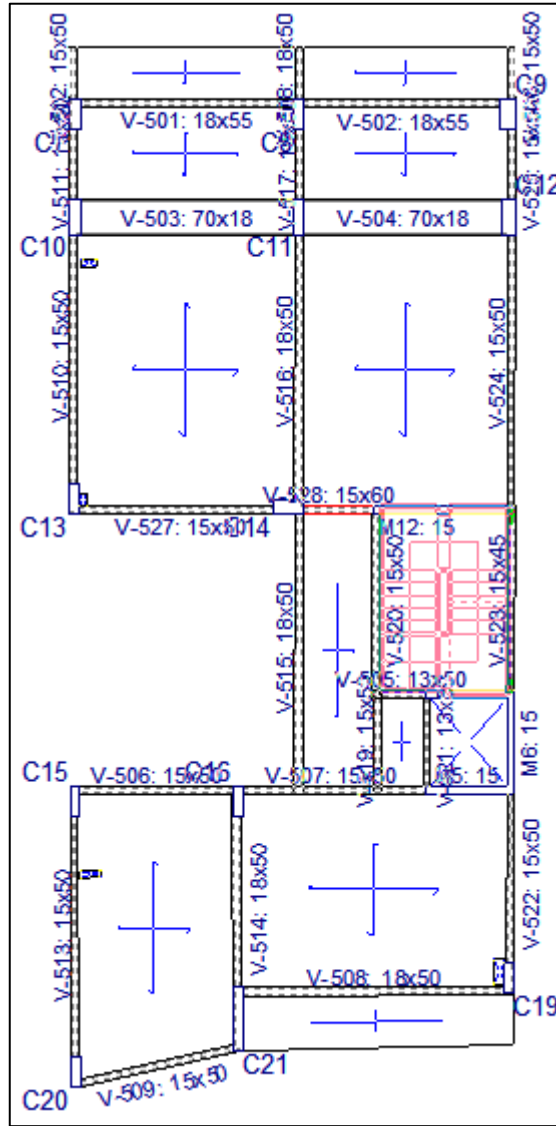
Introducción de elementos estructurales en modelo CYPECAD.
